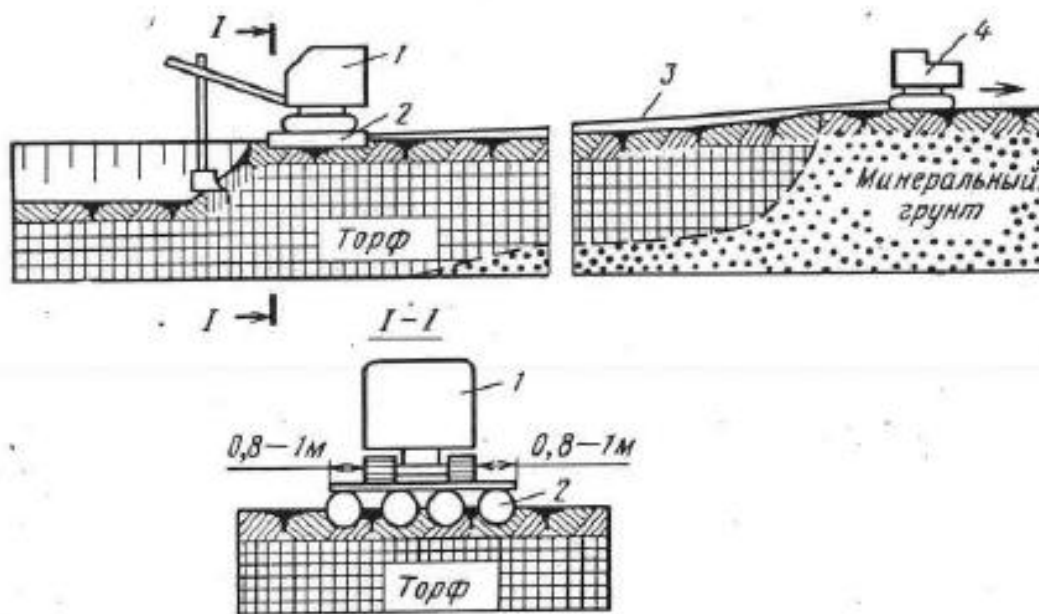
Схема разработки траншеи экскаватором на салазках
